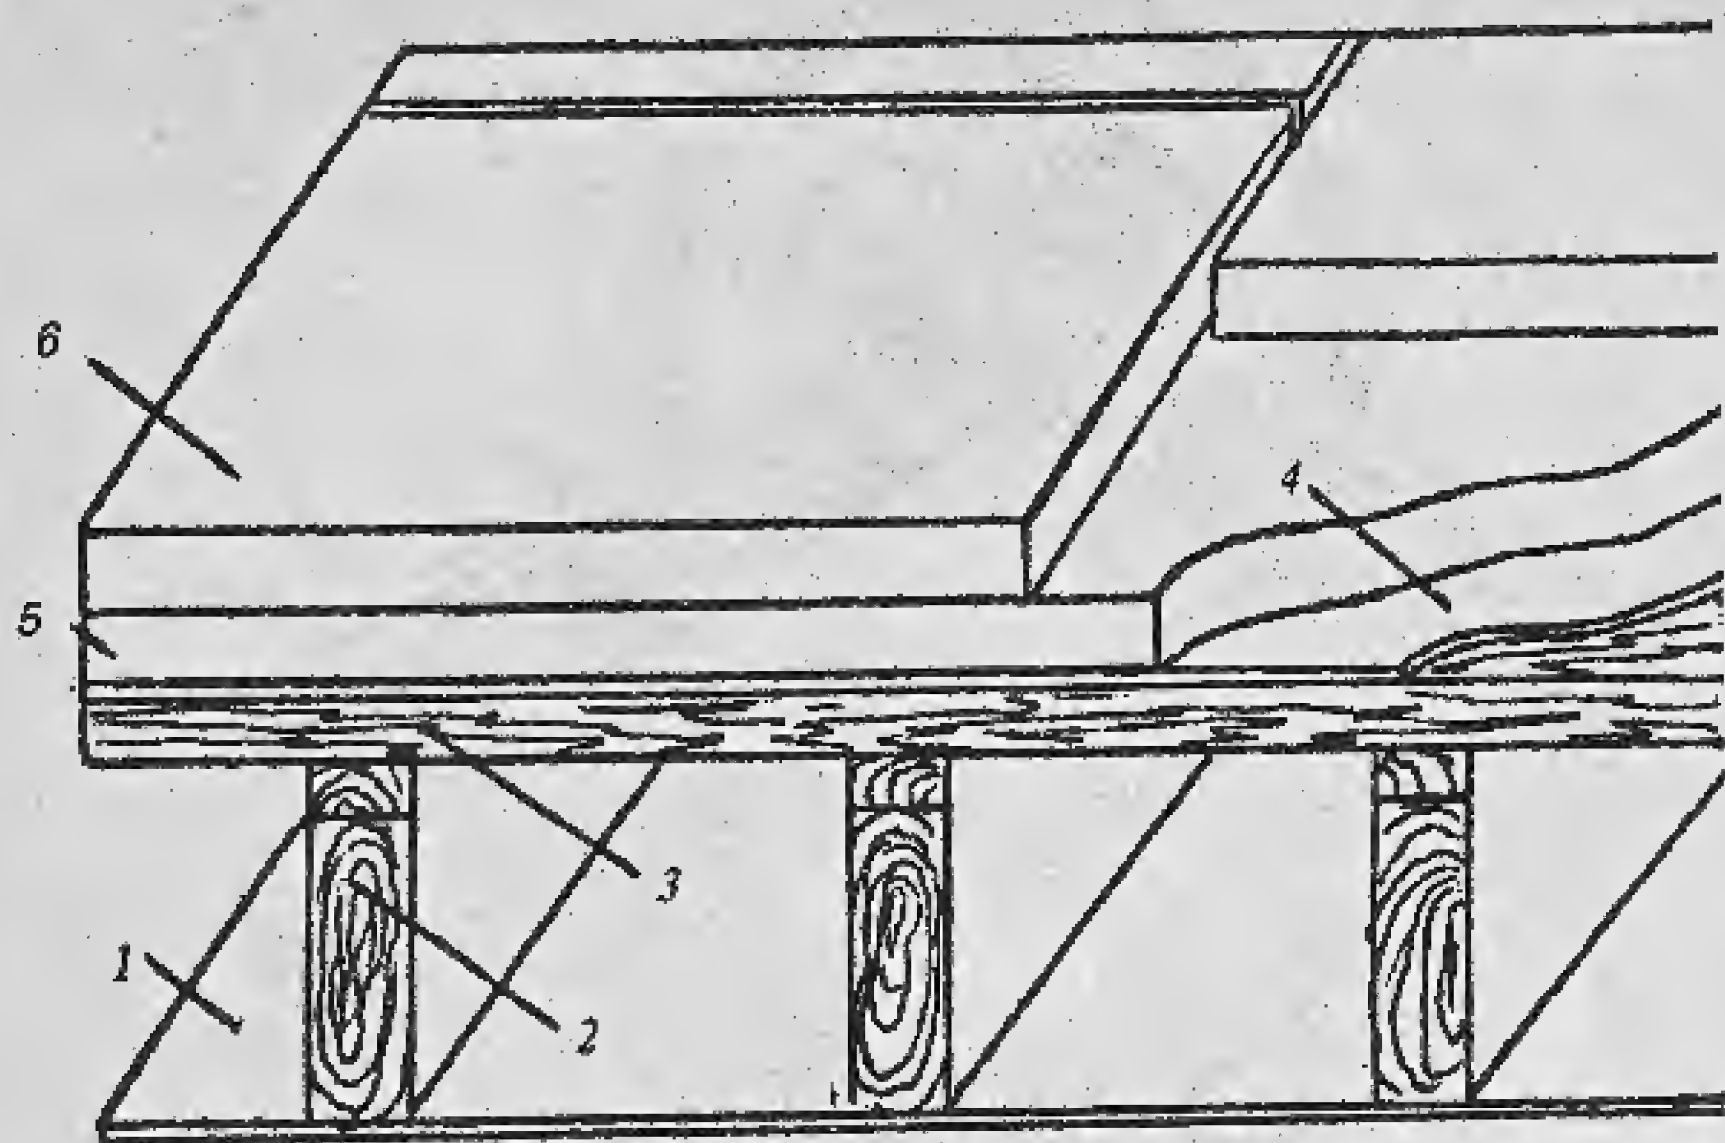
Зовнішнє утеплення плоского даху: 1 – стеля; 2 – брус несучої конструкції; 3 – дерев'яна панель; 4 – гідроізоляційне покриття; 5 – теплоізоляційний шар; 6 – тротуарна плитка.
